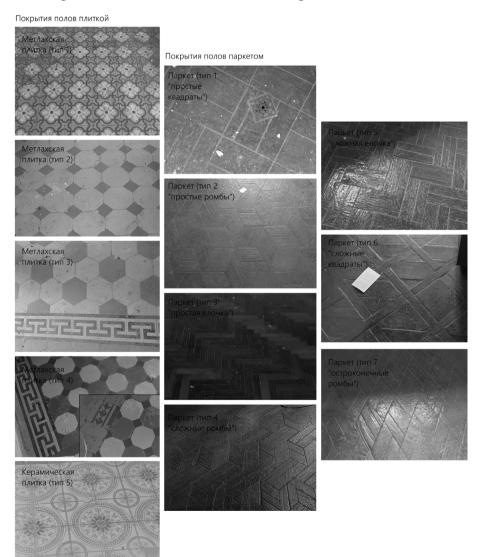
Типы напольных покрытий Fig. 9. Types of flooring
